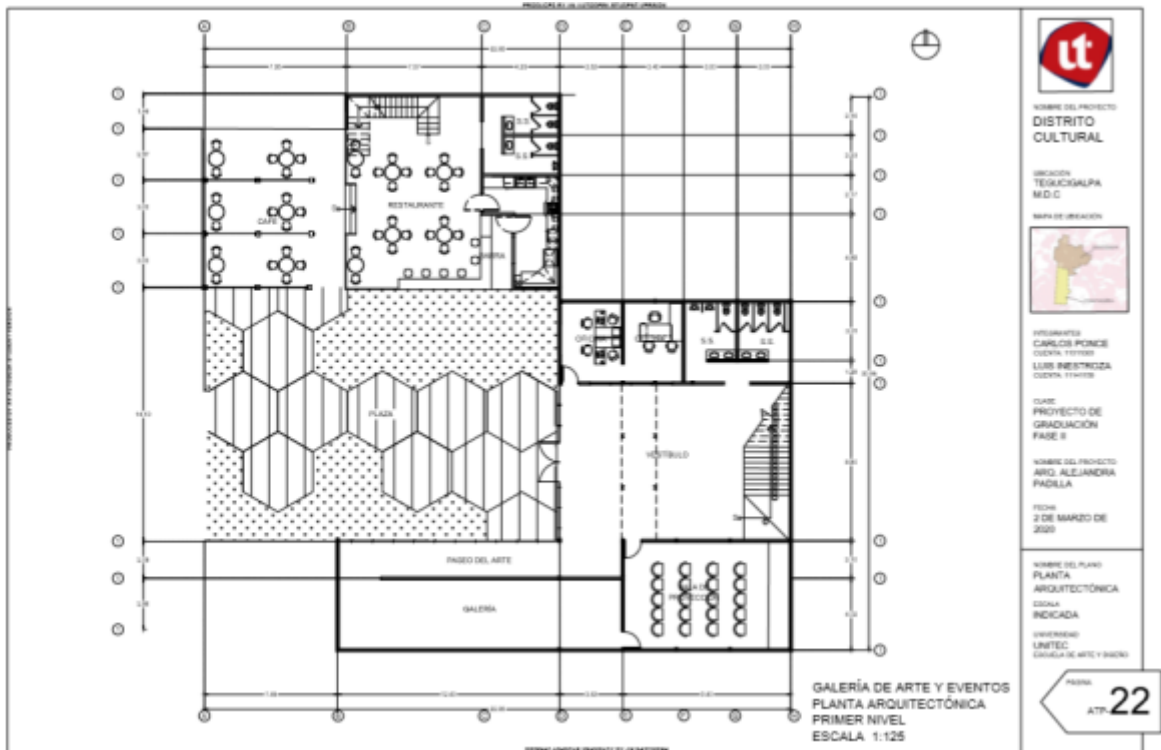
Planta Arquitectónica Galería de Arte y Eventos Primer Nivel
